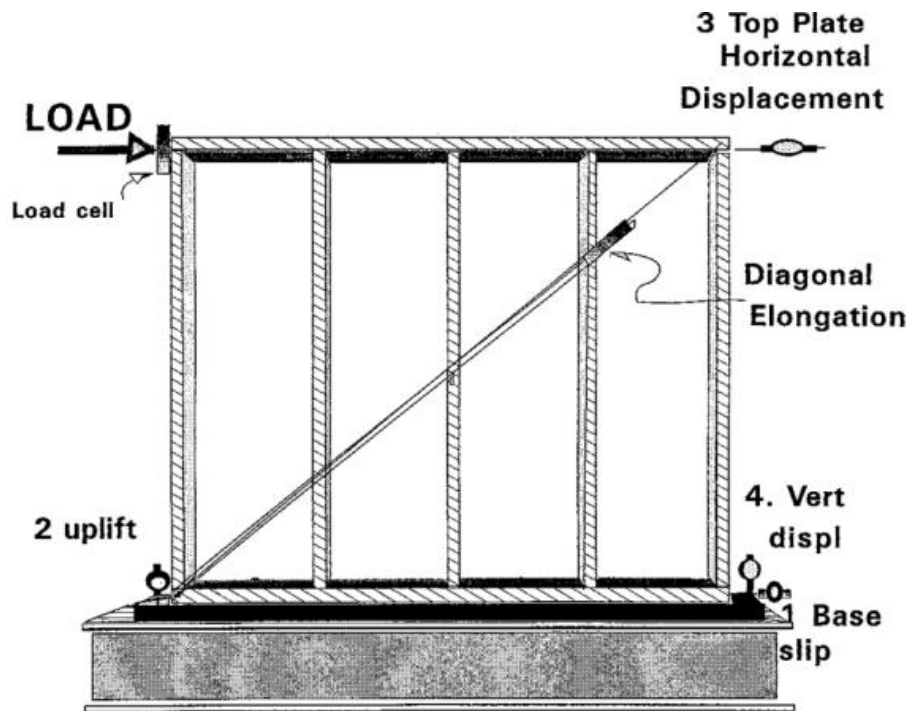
Disposición general de un ensayo mediante la ASTM E564-06. Fuente: [9]
